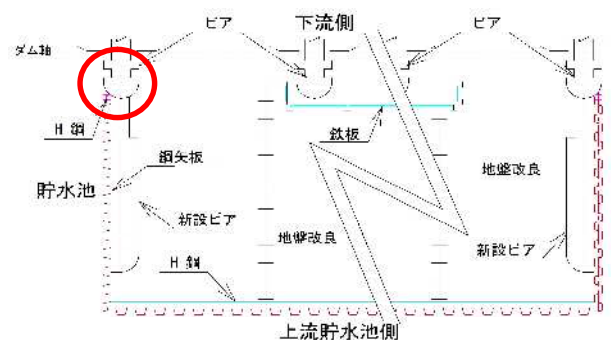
鋼矢板と堤体接合部の位置(上流締切平面図)
